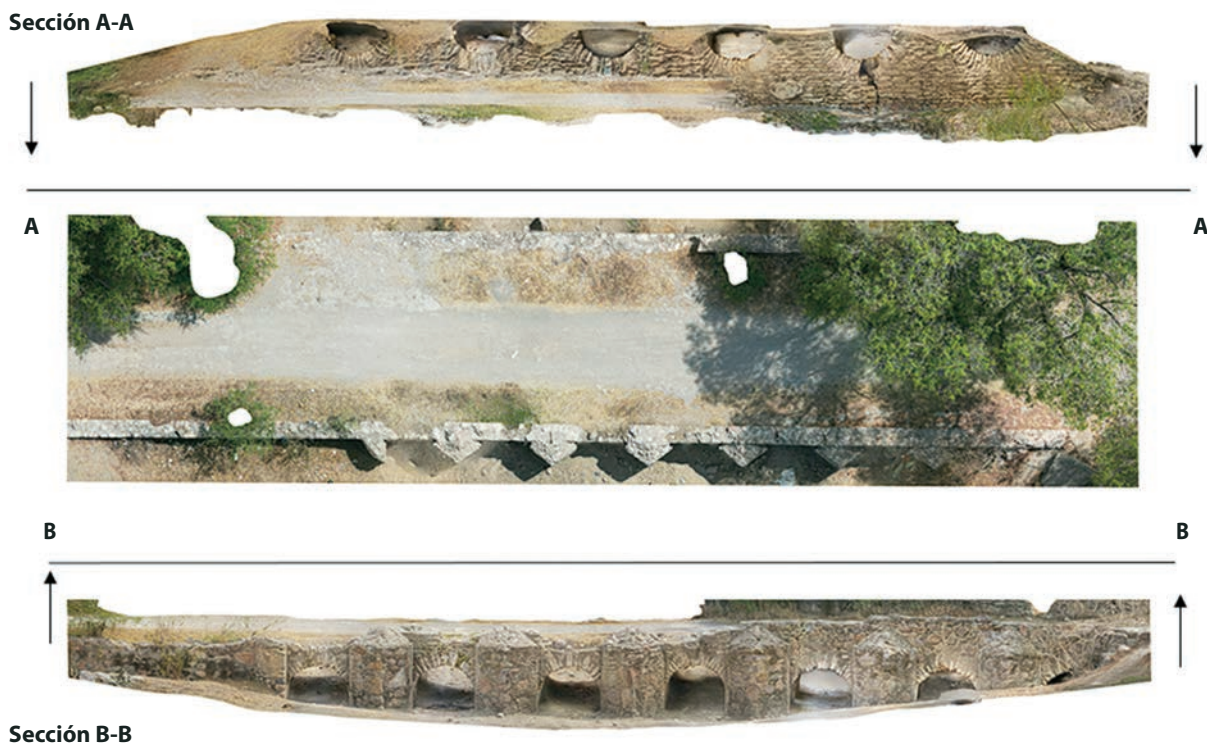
Ortofotos de planta y fachadas del puente El Tule.
